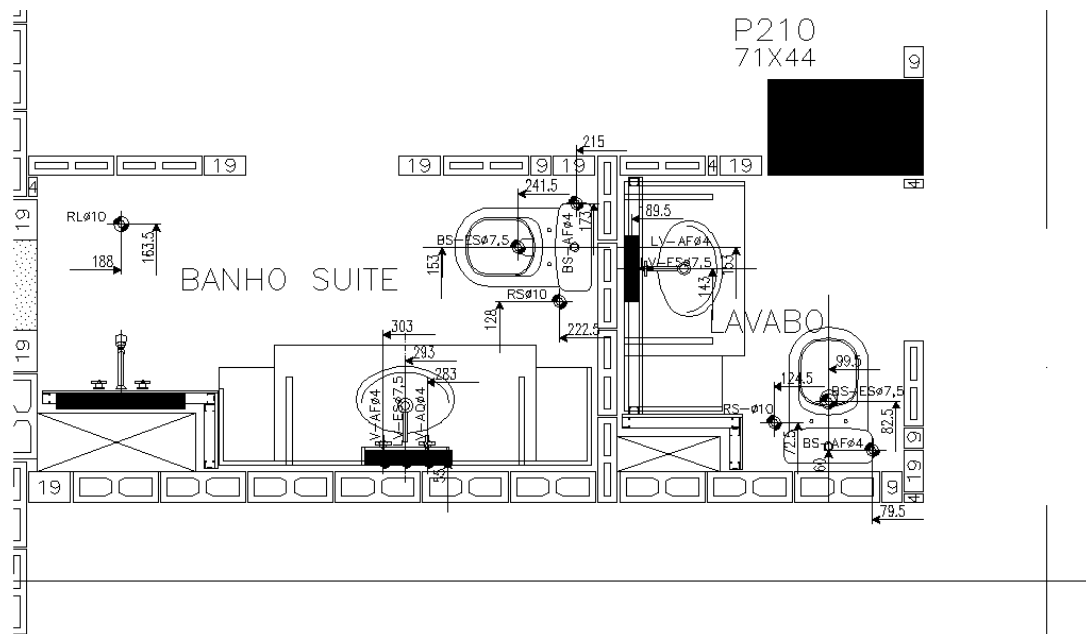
Projeto de Vedação. Fonte: Construtora, 2014.
